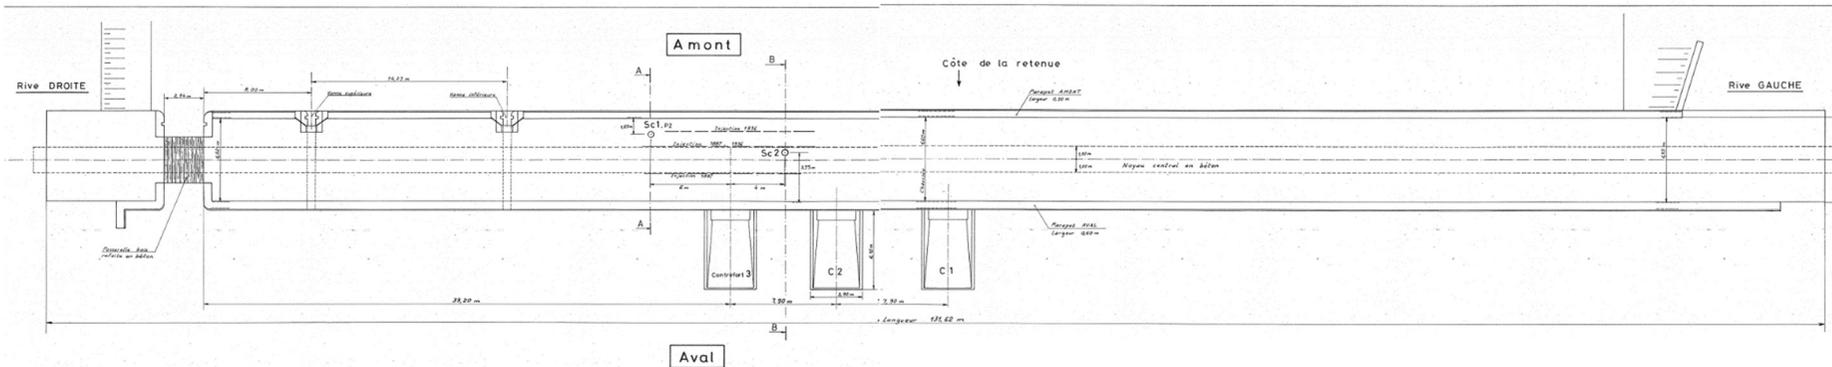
Vue en plan de l'ouvrage avec localisation des coupes type (source CETE 1987)
